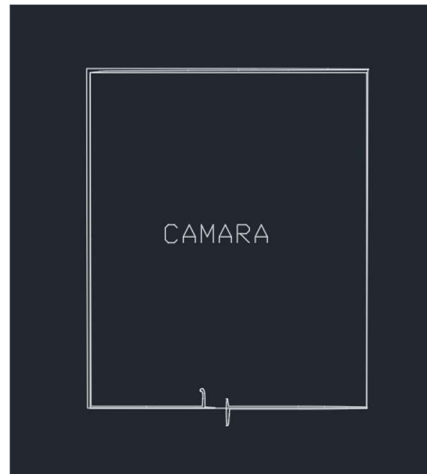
Plano de la primera planta de la primera inmediación. Elaboración propia
